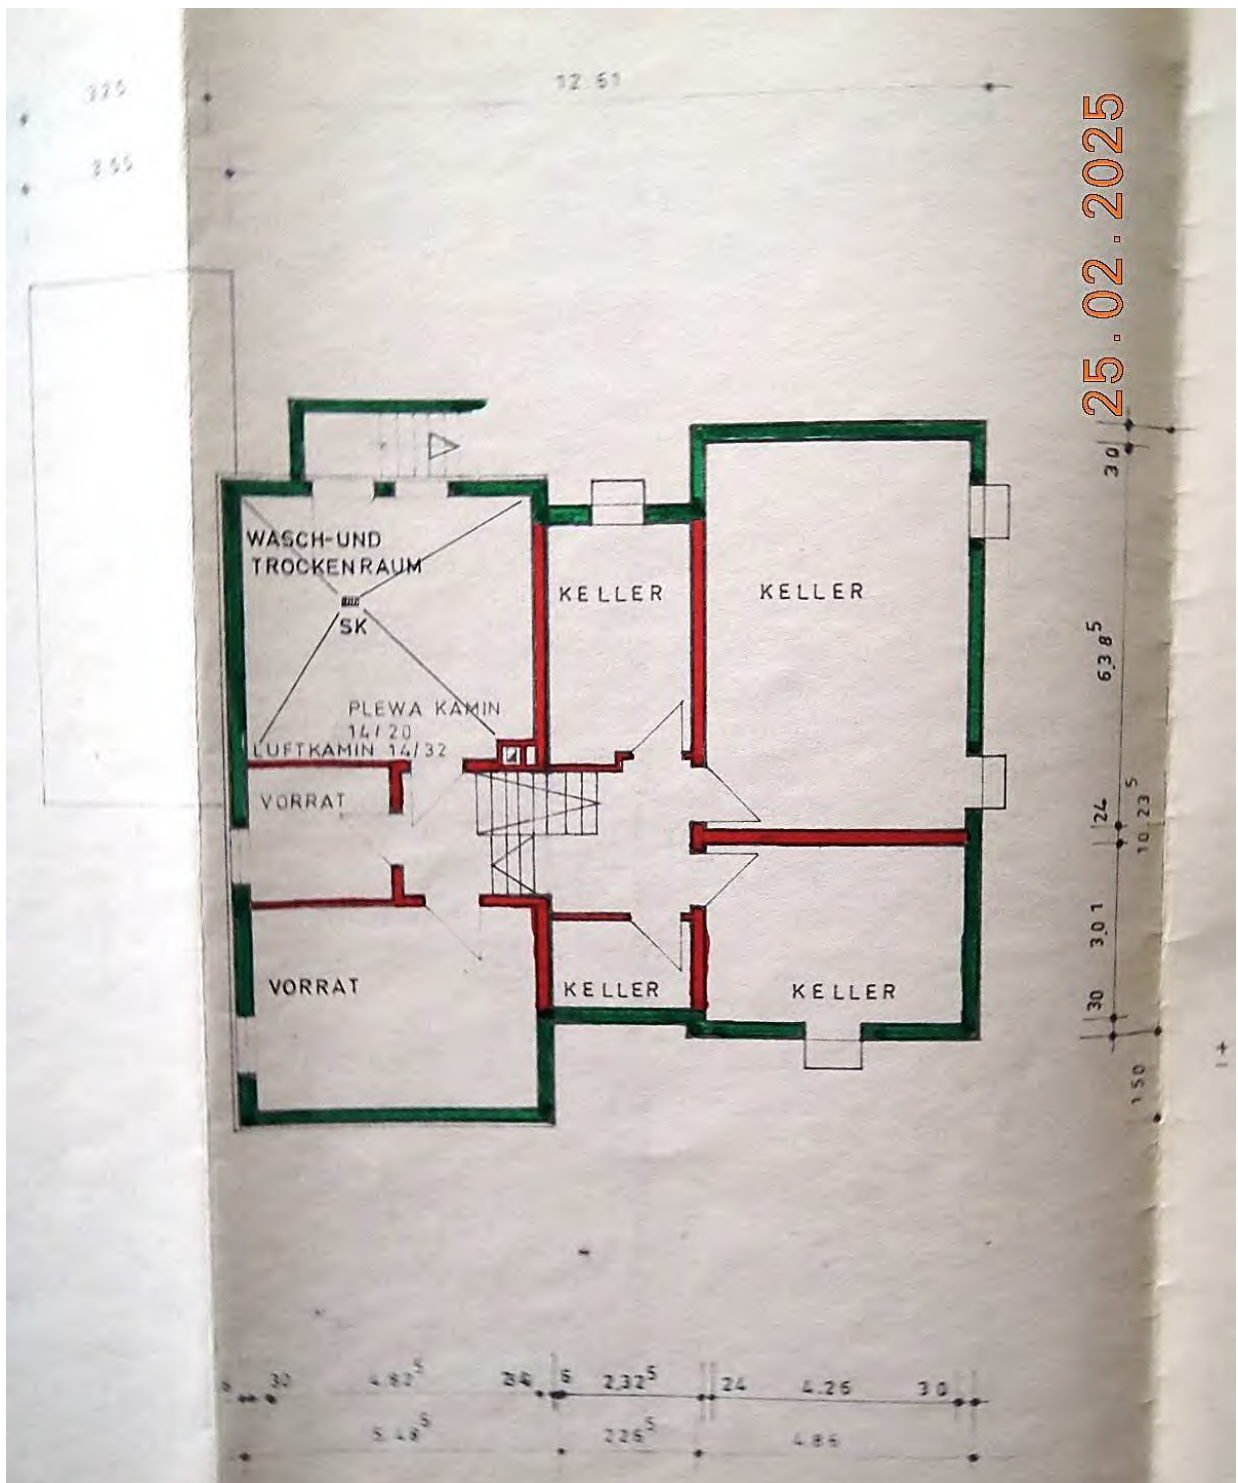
Grundrissplan Kellergeschoss (aus Bauakte 1972)
